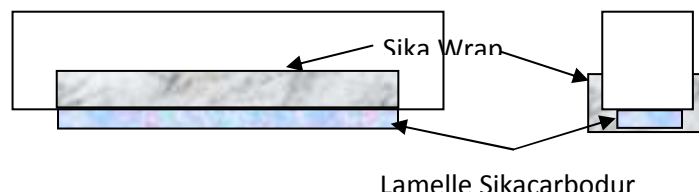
Double renforcement aux faces latérales et face inférieure [13]
